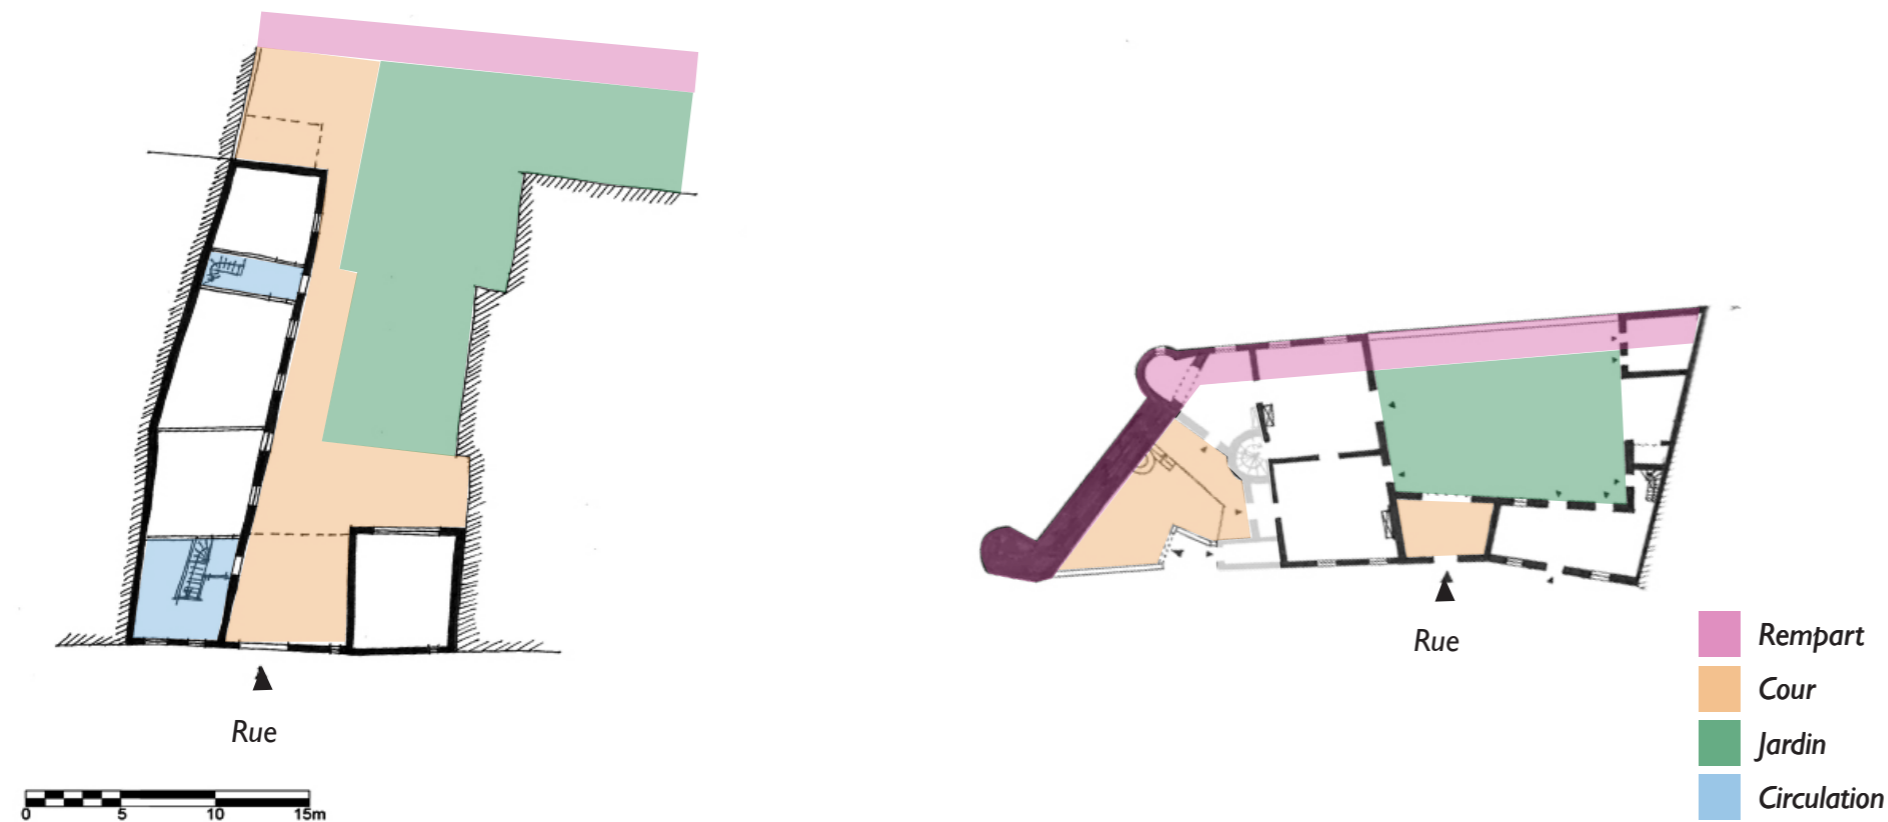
Plans rez-de-chaussée des hôtels particuliers et maisons de ville avec porche
